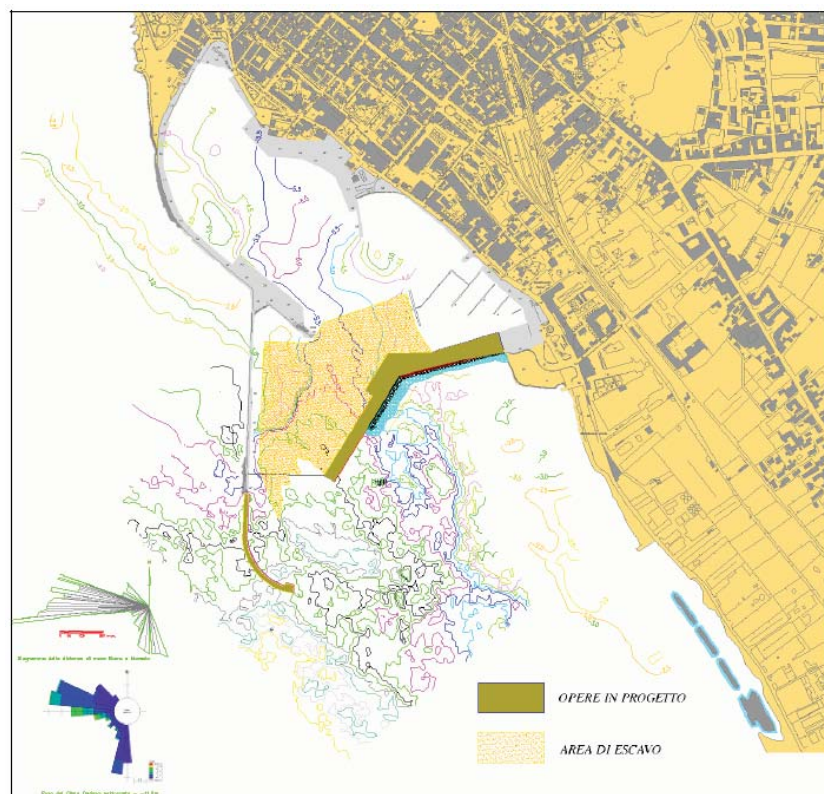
Configurazione del porto prevista nel Progetto Pubblico
